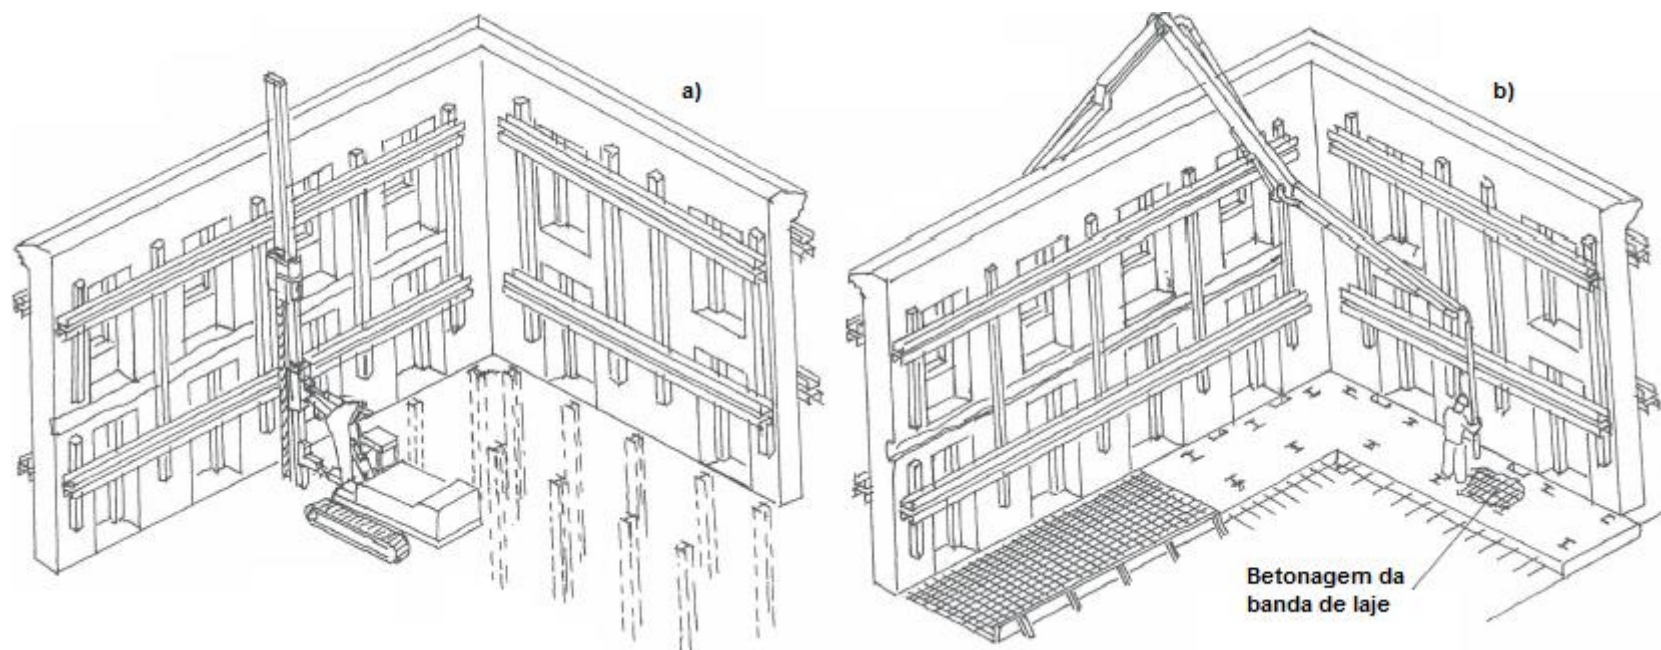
Construção da cave: a) instalação dos perfis; b) construção das bandas de laje [55]
